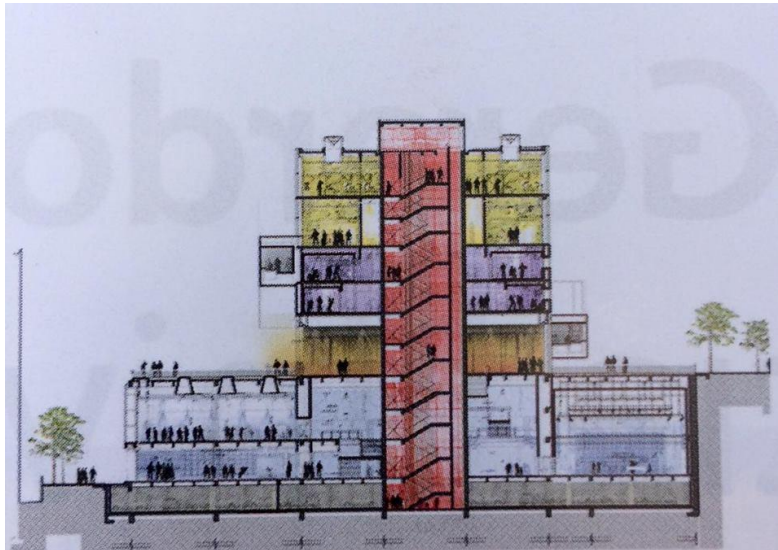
Render arquitectónico Edificio Gerardo Arango (Construdata, 2016)
